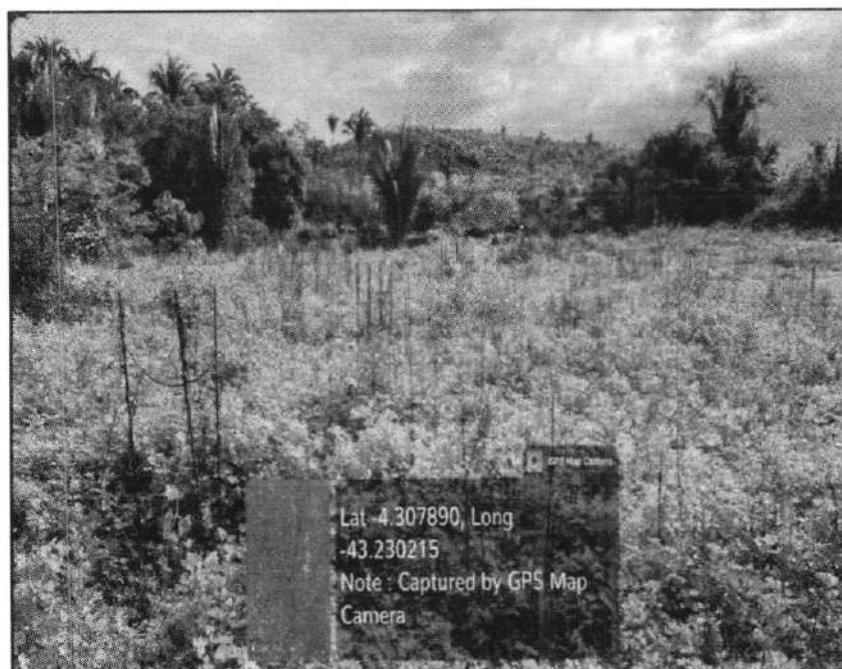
Ferragens dos blocos de fundação sem concretagem previstas e expostas a intempéries. Fonte: elaboração própria
